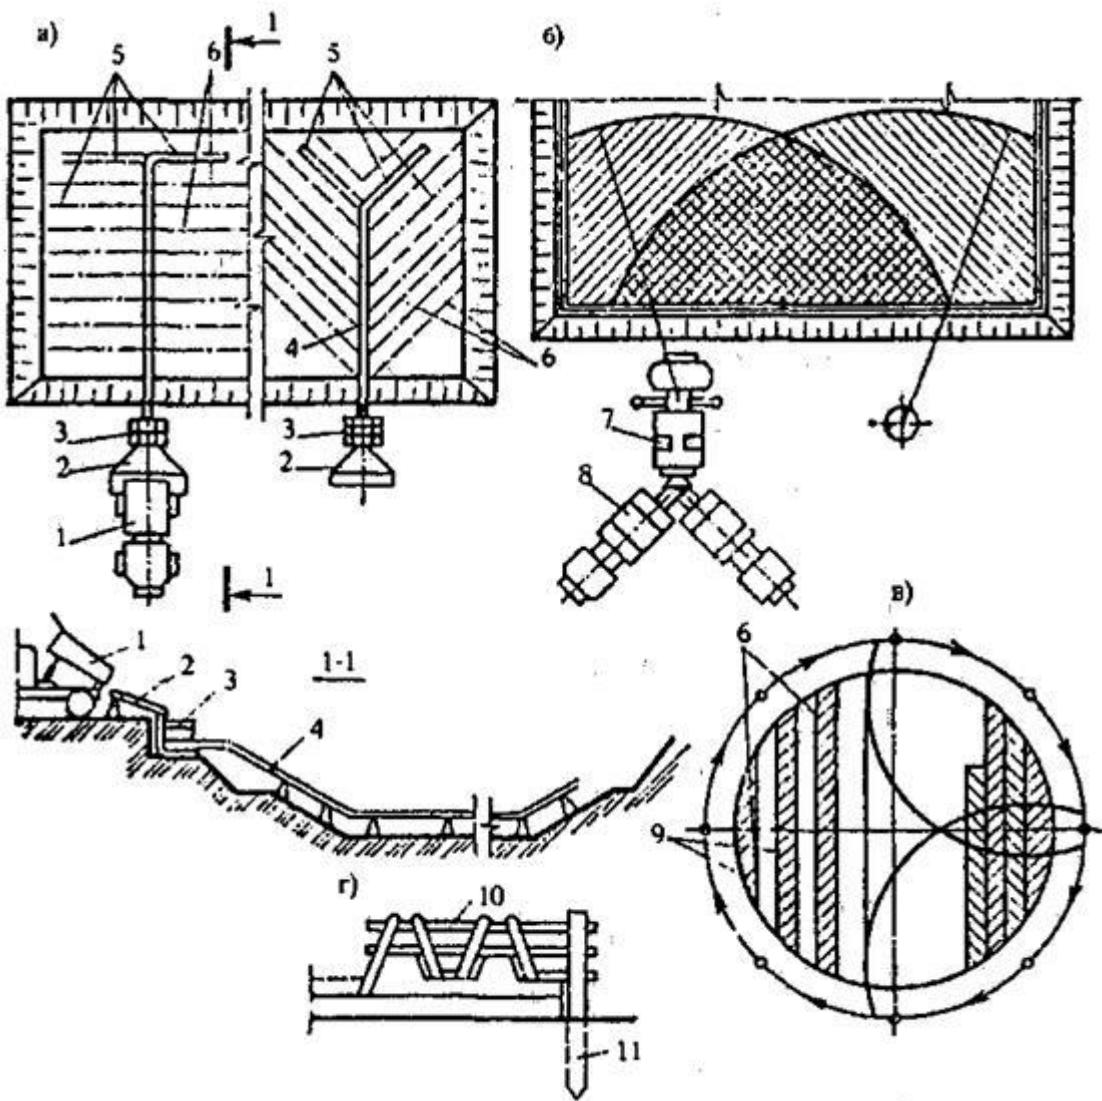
Схема укладки бетонной смеси бетононасосами и устройства опалубки днища:
